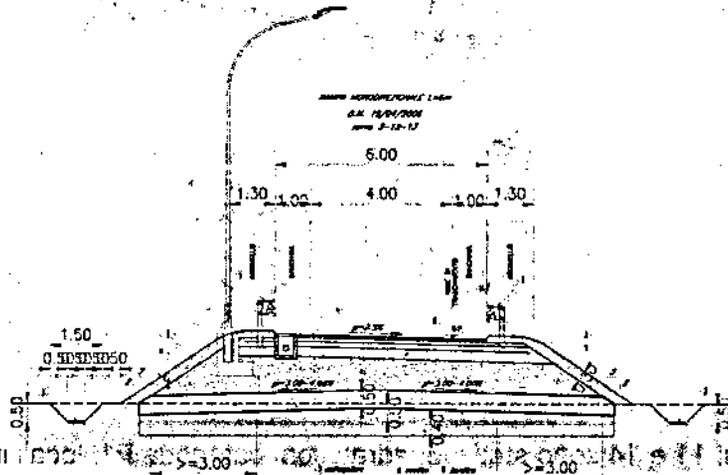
Sezione tipo rampa monodirezionale in rilevato alto
